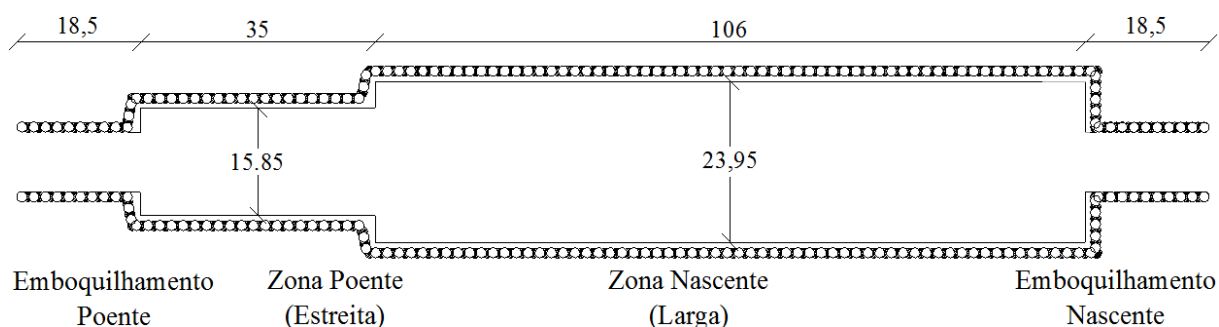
Planta da cortina de contenção da Estação Terreiro do Paço (adaptado de Cruz, 2006)
